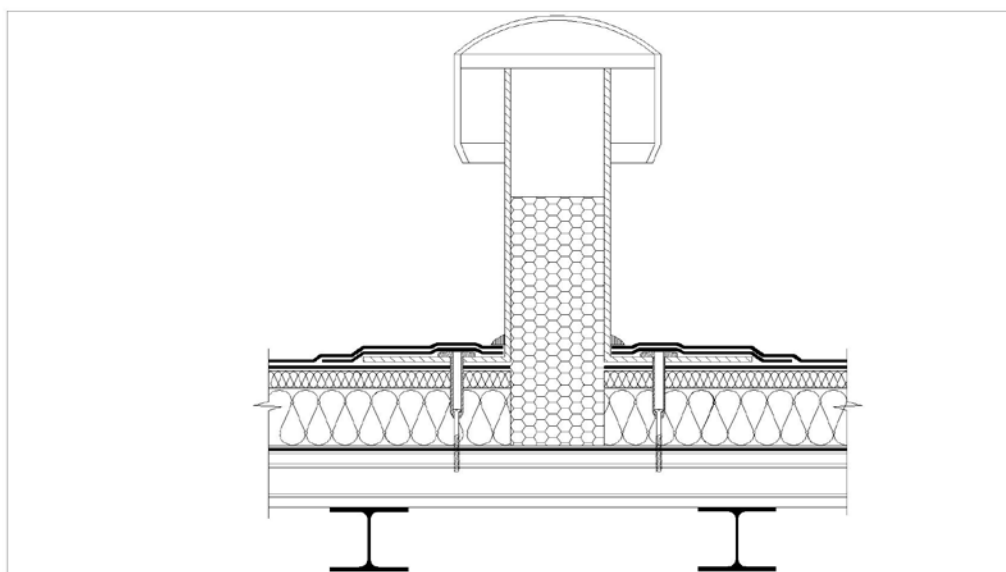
Вентиляционный элемент на плоской крыше (аэратор)
